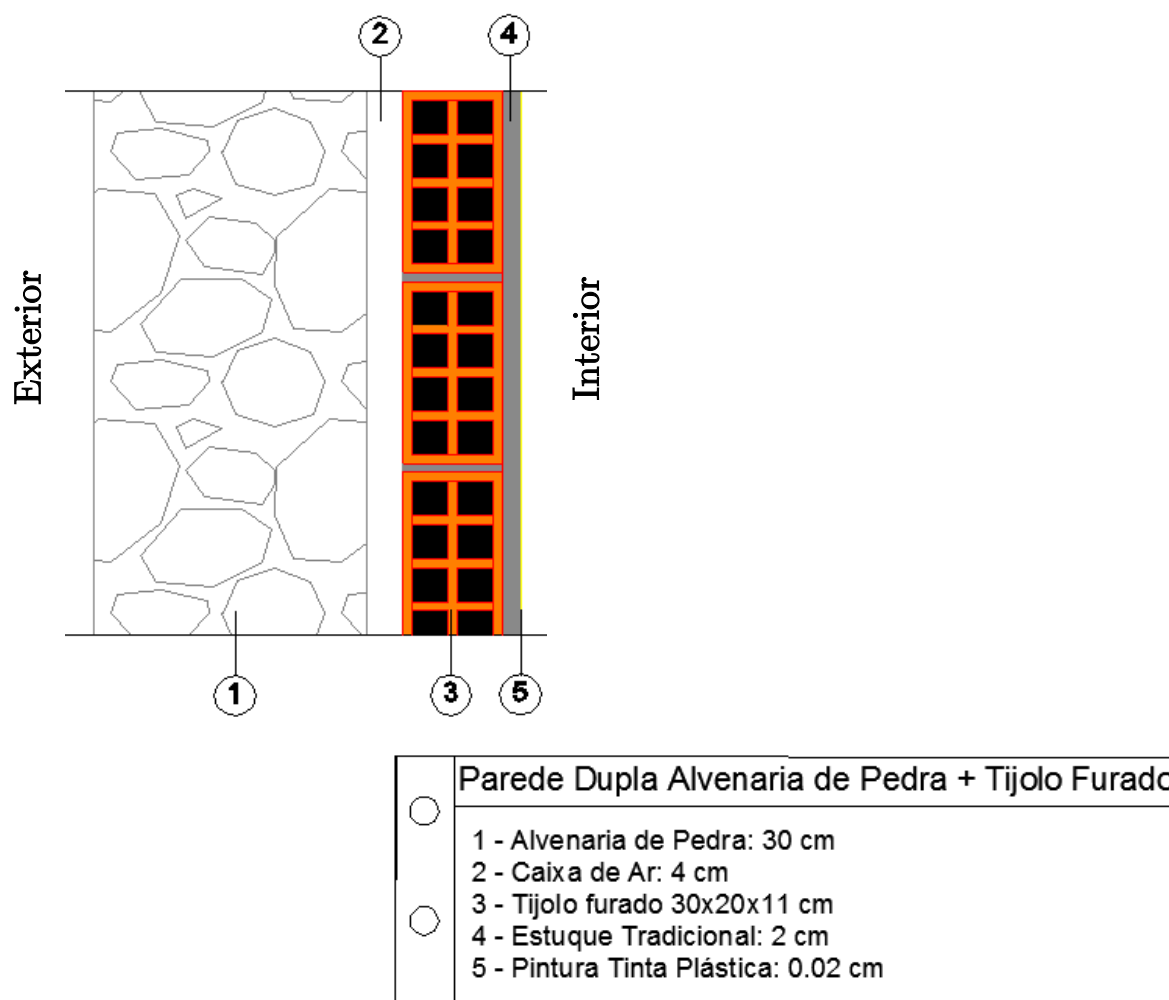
Parede dupla de alvenaria de pedra pelo exterior e tijolo furado pelo interior
